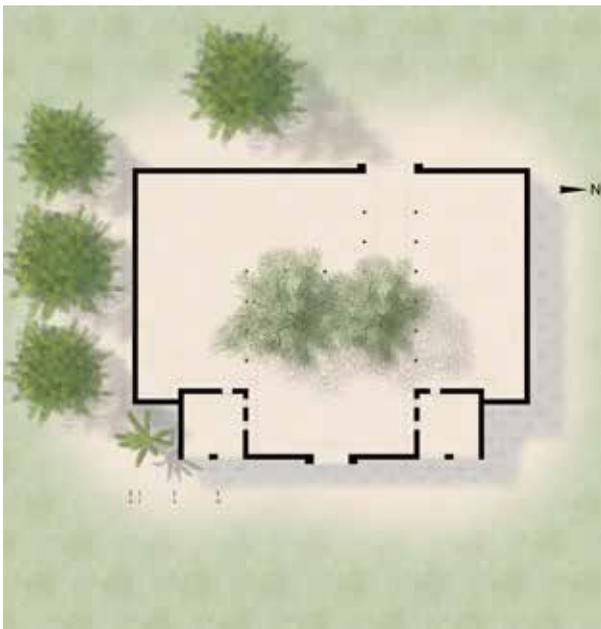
| Planta de las caballerizas. Ilustración: D. García.
